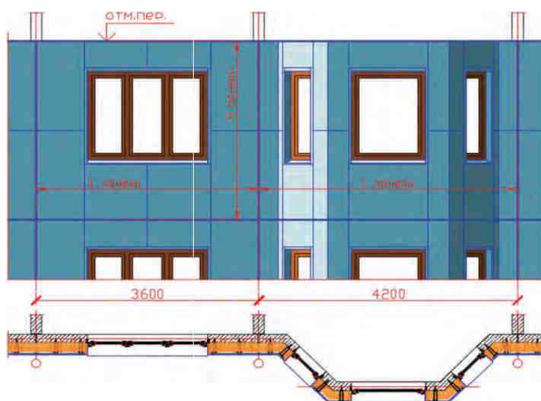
Схема размещения вентфасадных панелей на фрагменте типового этажа панельного дома
